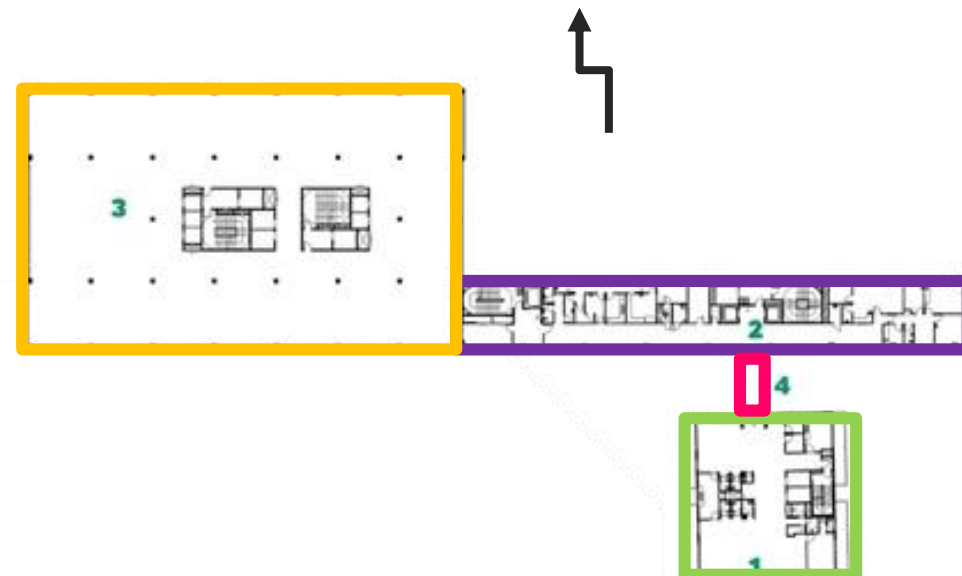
Planta baixa do Edifício GRAACC – Primeiro Pavimento
